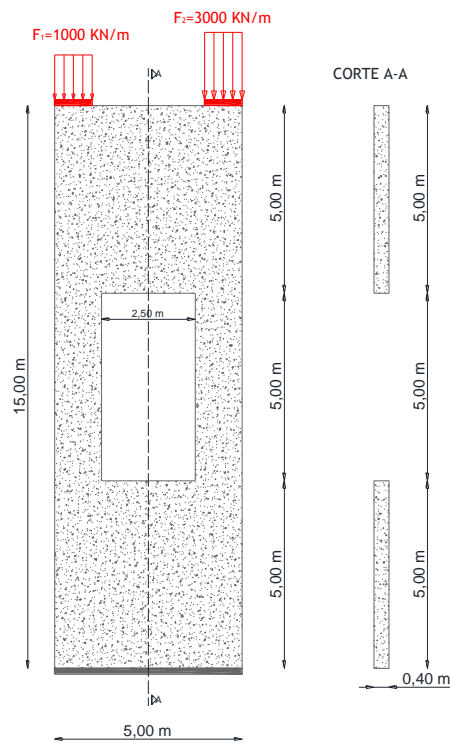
Características geométricas da parede e condições de carregamento externo. Vista em alçado, corte transversal relativo ao meio vão da parede e respectivas dimensões.
